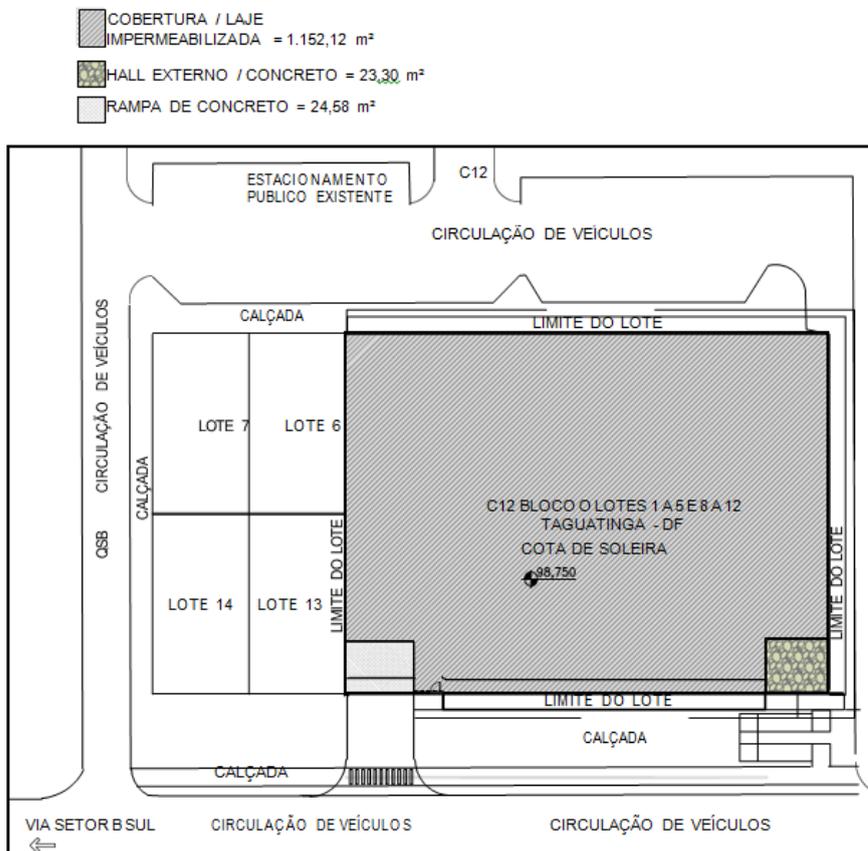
Planta de áreas impermeáveis Fonte: construtora combral – 2018
